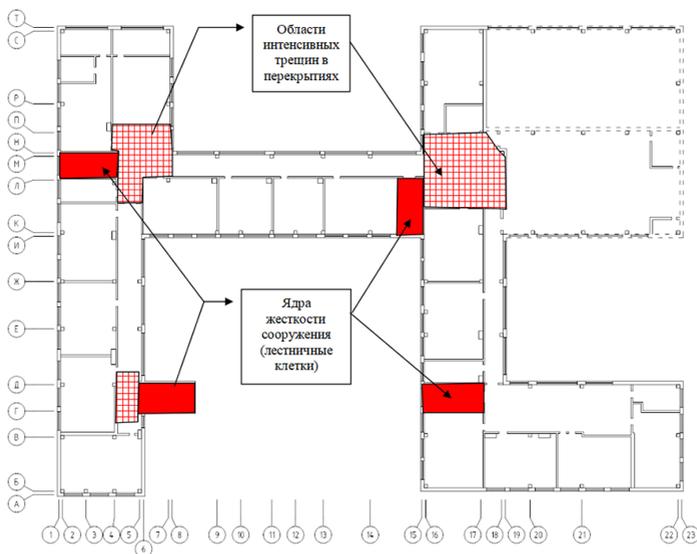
Схема расположения областей перекрытий, поврежденных трещинами, и ядер жесткости здания в виде лестничных клеток
